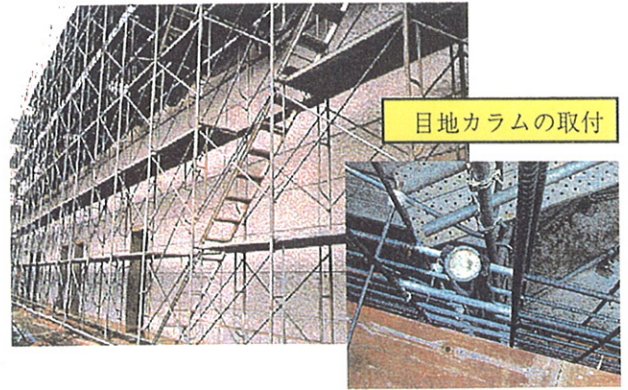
カラム目地工法を採用した建物外壁 Walls in the Building Applied COLUMN Joiner
